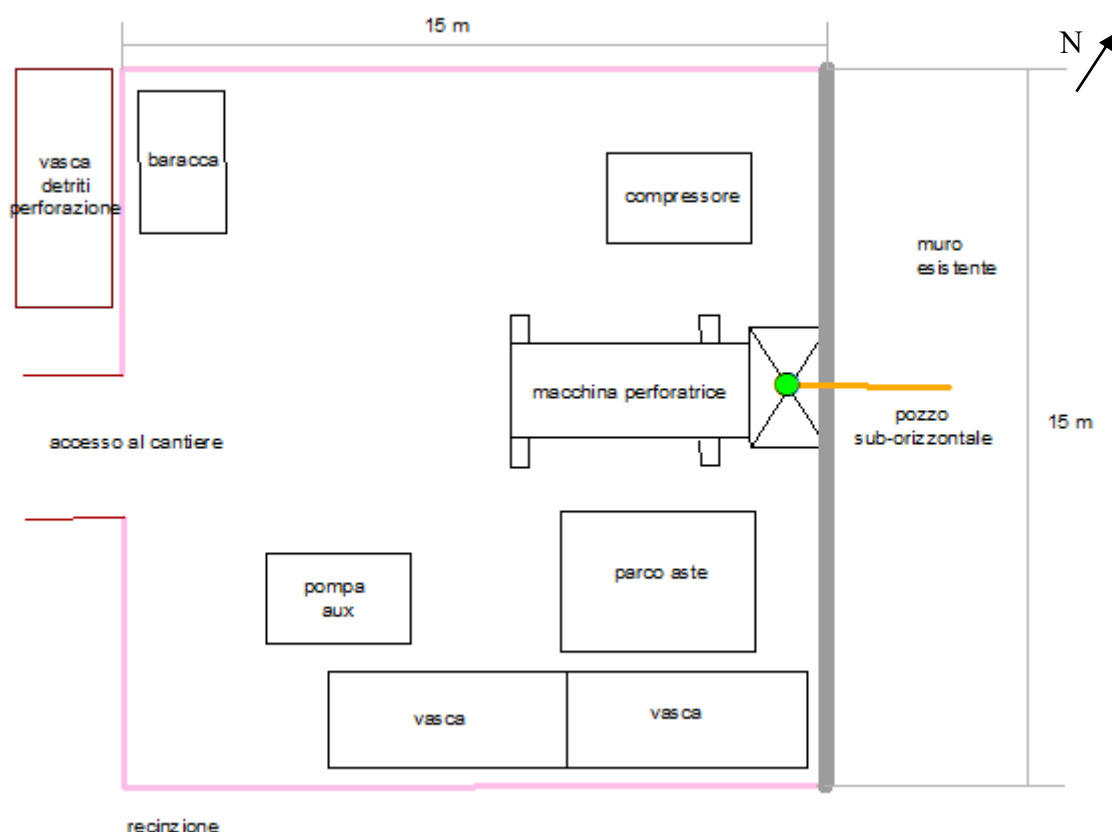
Layout di cantiere dei pozzi sub-orizzontali 4 e 5 con i principali equipments (estratto da Allegato 1 – Tavola schema cantiere)
